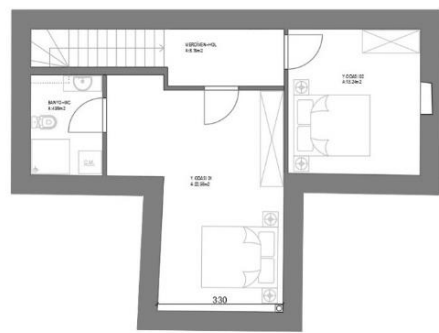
Zemin Kat Planı (Restitüsyon)
